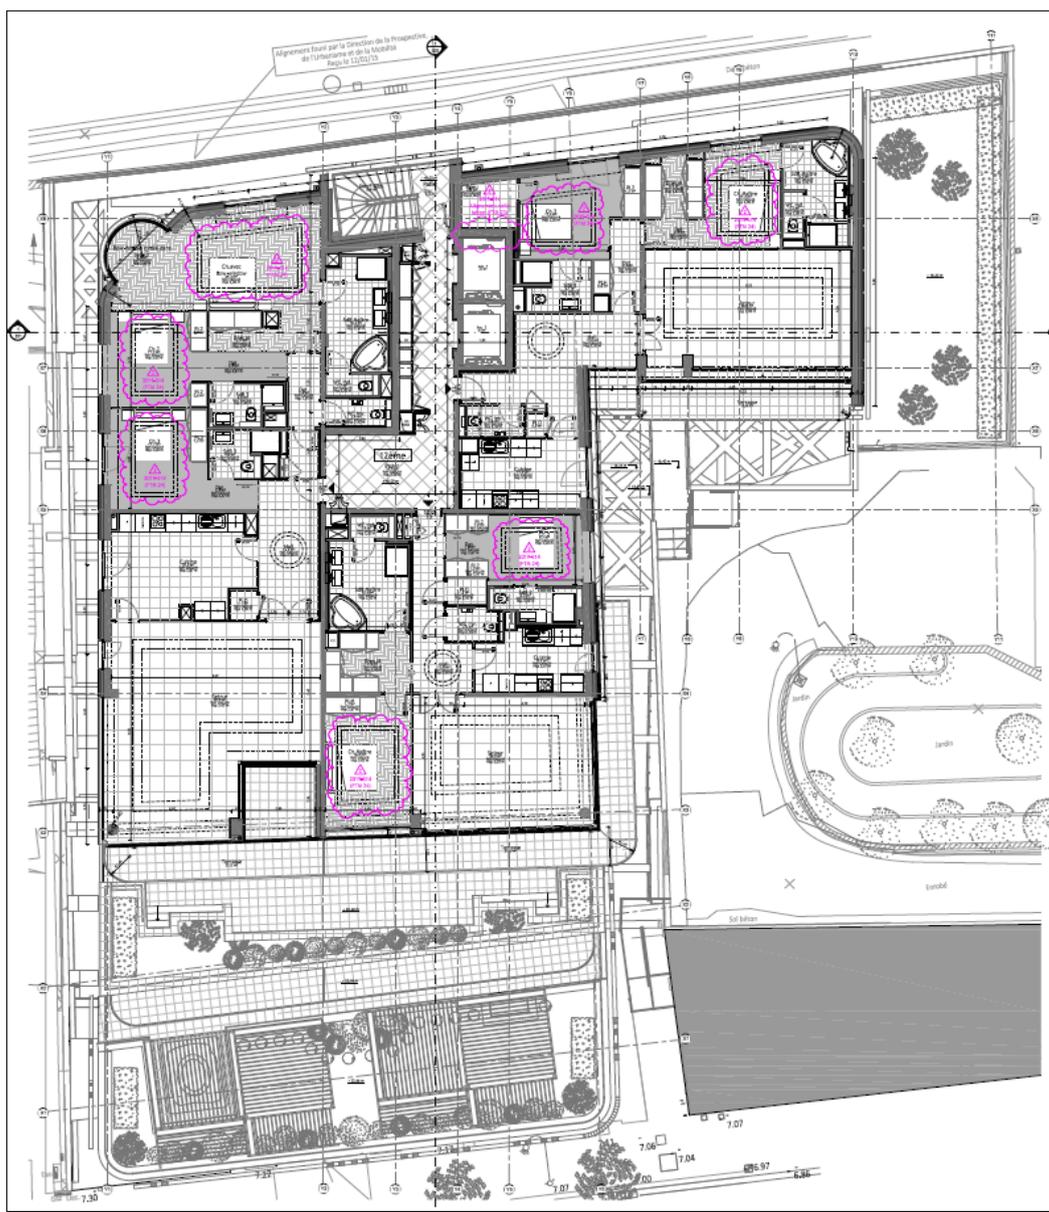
Pianta architettonica, dodicesimo piano (R+12)
